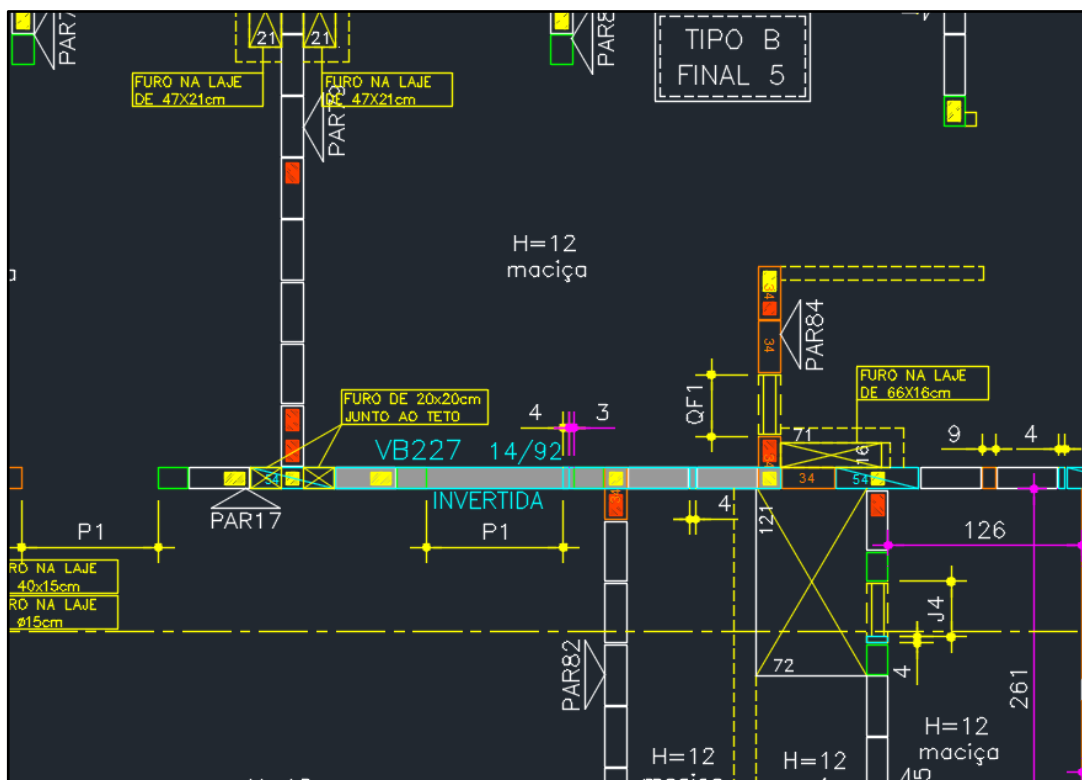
Projeto estrutural do primeiro pavimento (empreendimento estudo de caso)
